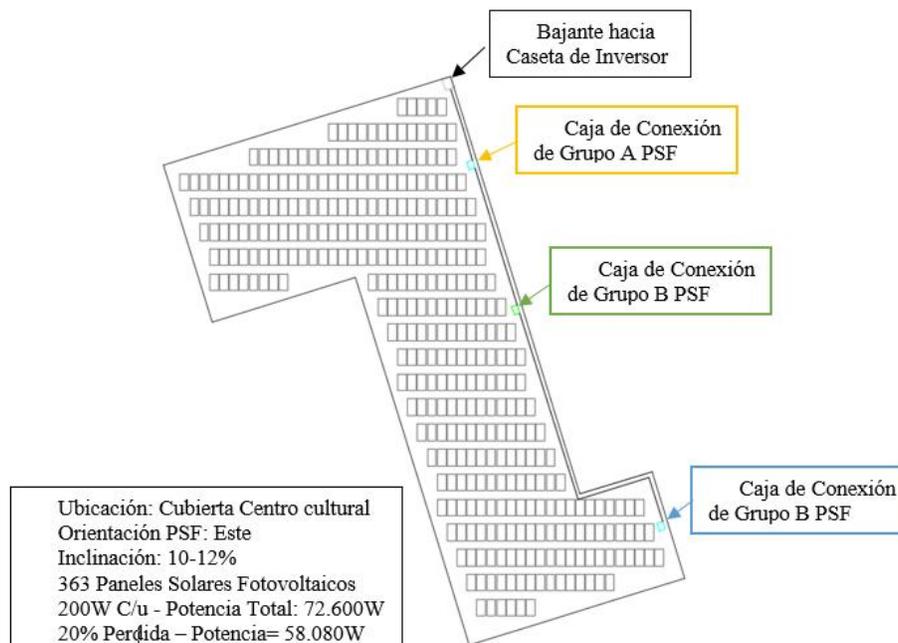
Plano Detalle Colocación de Paneles Solares Fotovoltaicos
